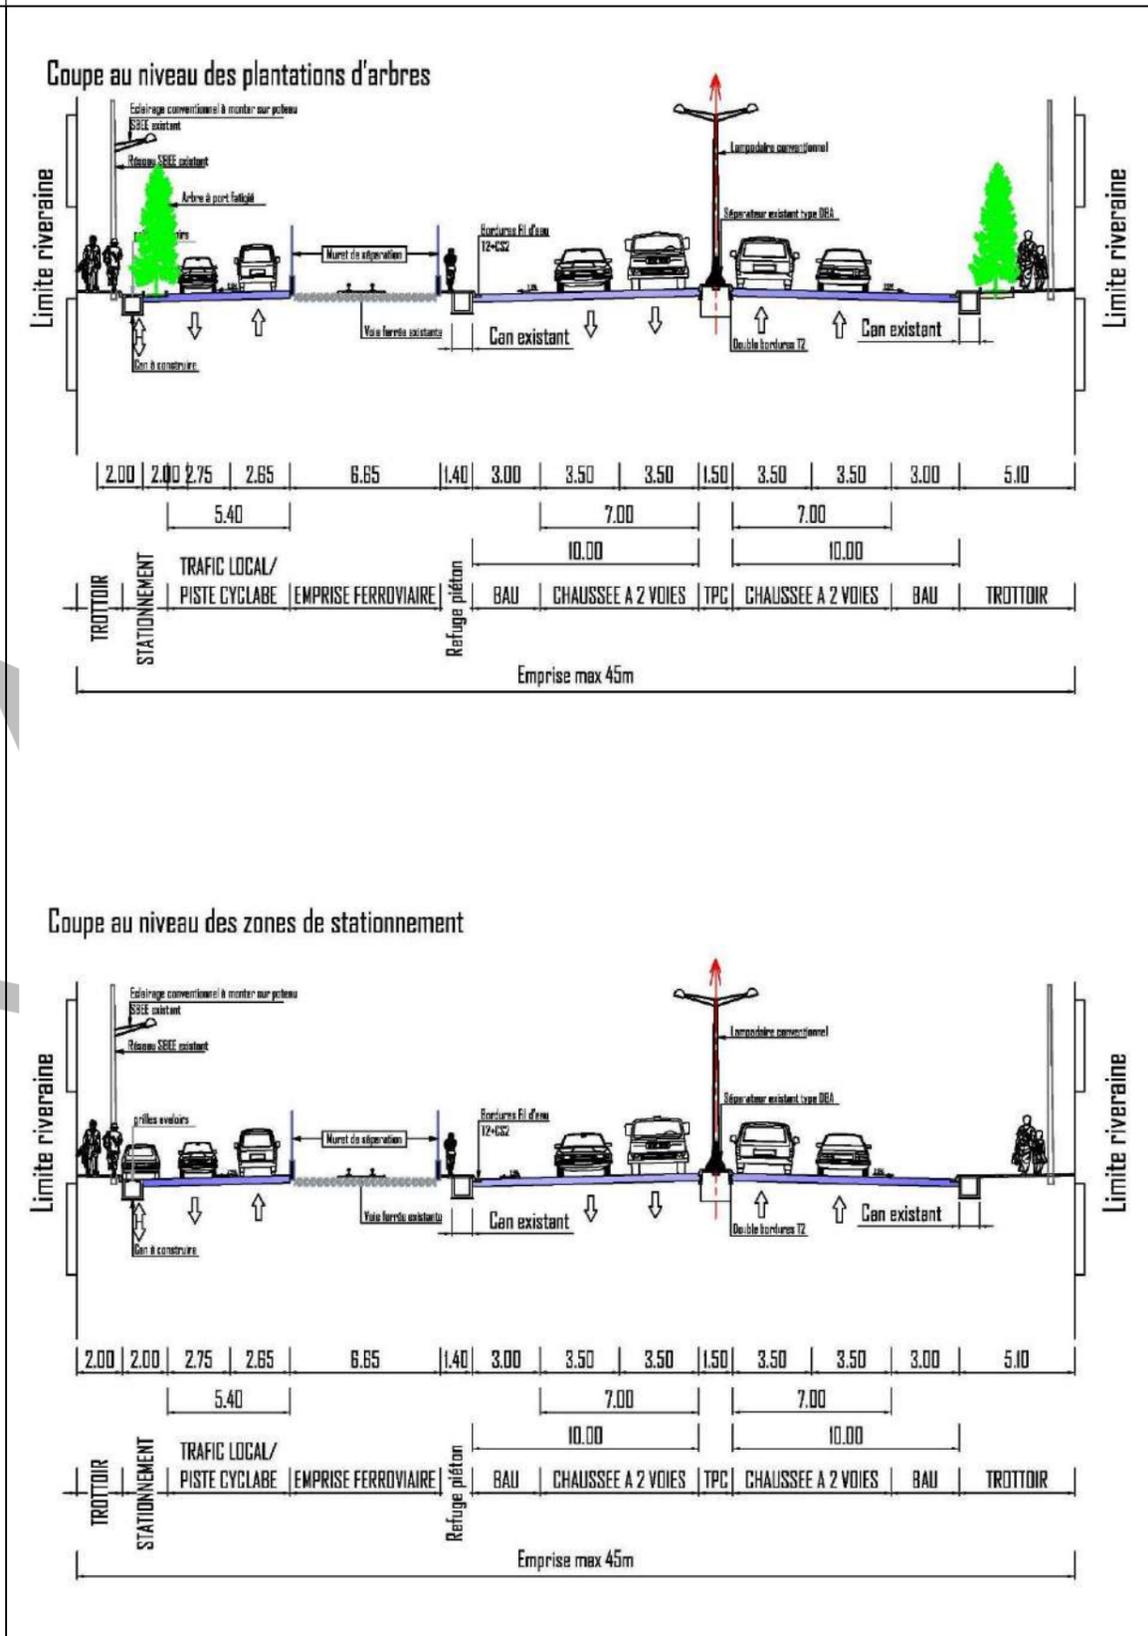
Profil en travers pour la Section Carrefour SOBEBRA – Carrefour Japan Motors
